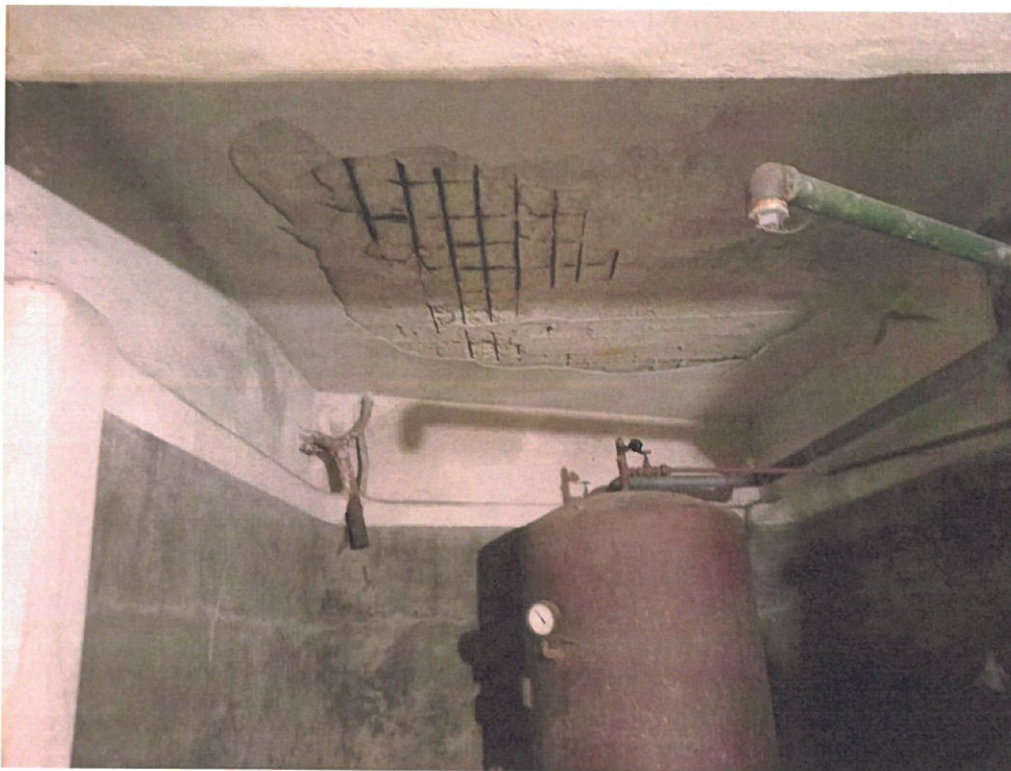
Strat de acoperire cu beton expulzat și armătură corodată – planșeu subsol
